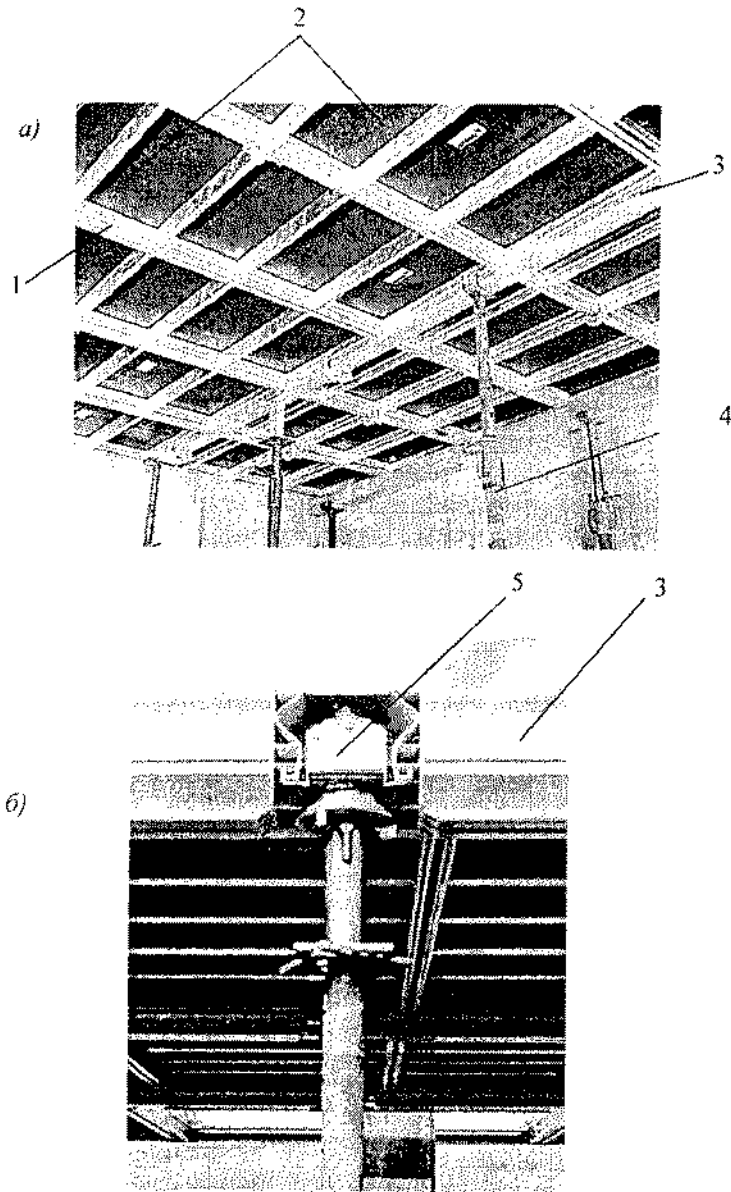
Опалубка перекрытий фирмы «Мева»:
